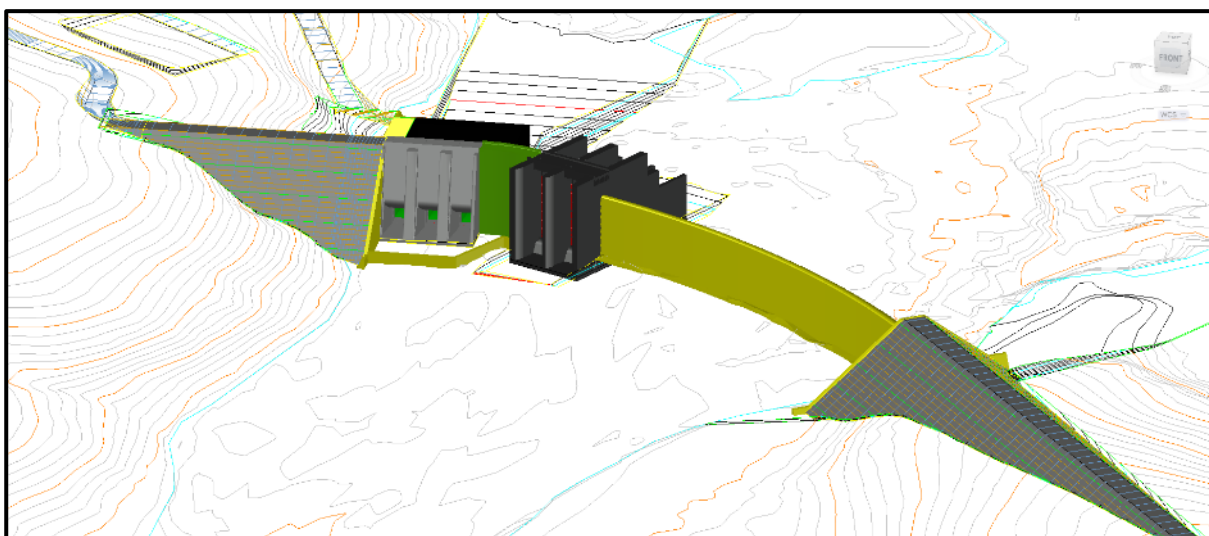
Arranjo geral da PCH Canoas. - vista de montante.
